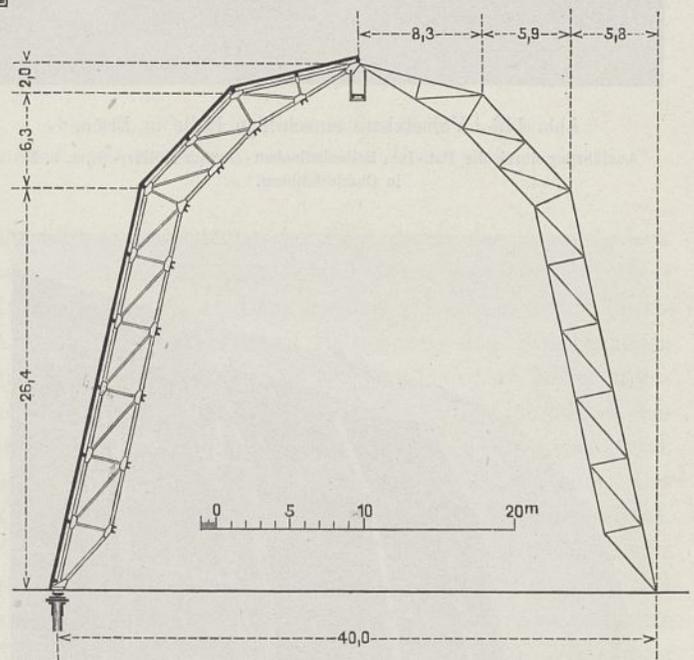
Versetzbare einschiffige Halle in Eisen.
